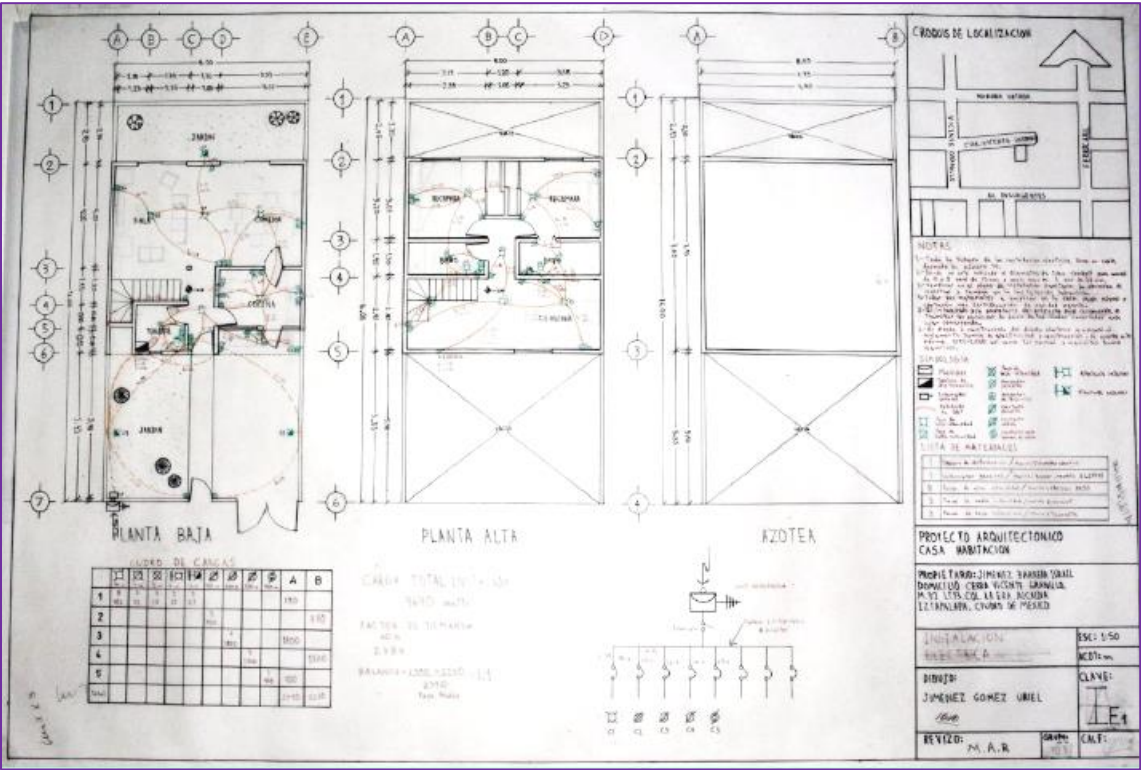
Ejemplo de plano terminado de la Instalación Eléctrica
